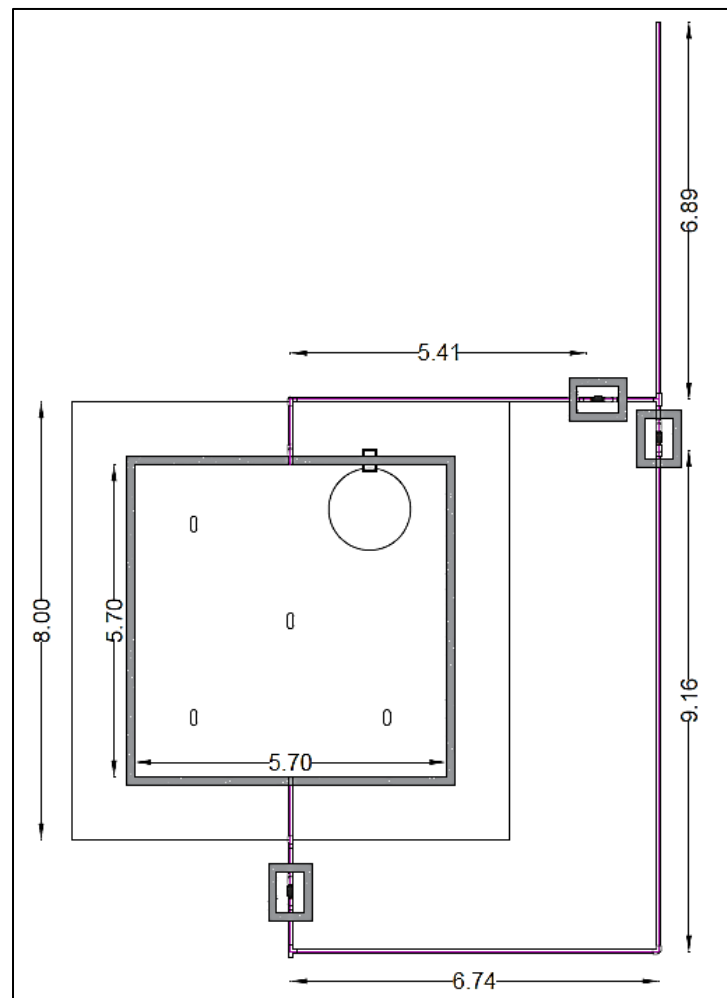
Vista en planta del tanque elevado. Fuente: Elaboración propia.
